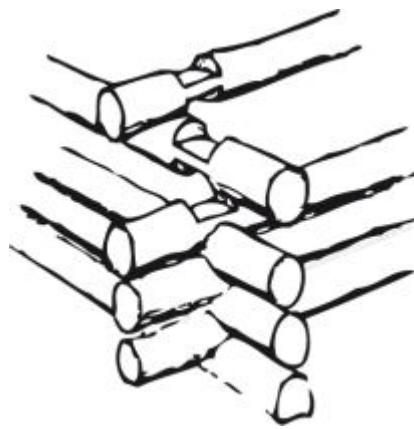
Exemple d'emboîtement à mi-bois des poutres
